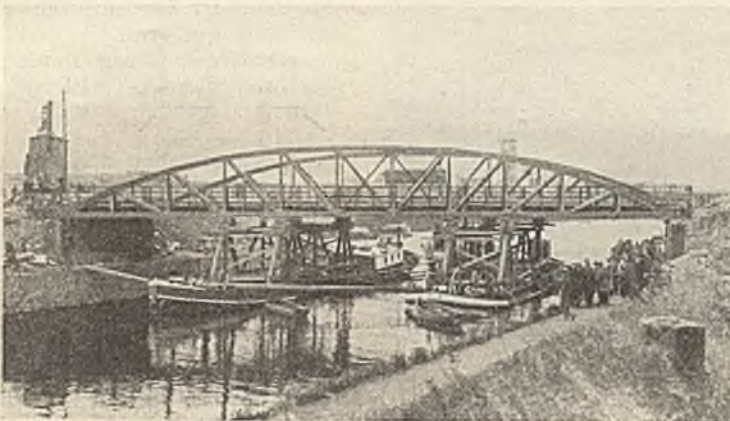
Die Brücke kurz vor dem Abfahren von der ursprünglichen Stelle.
